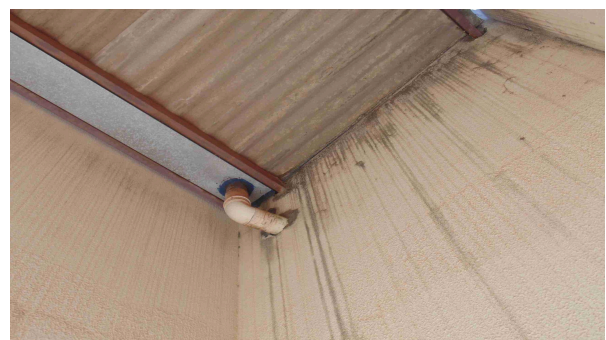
Detalhe da calha, telhas e perfis metálicos da estrutura do telhado, que aparentava possibilidade de infiltrações próximas às paredes pela ausência de rufos
